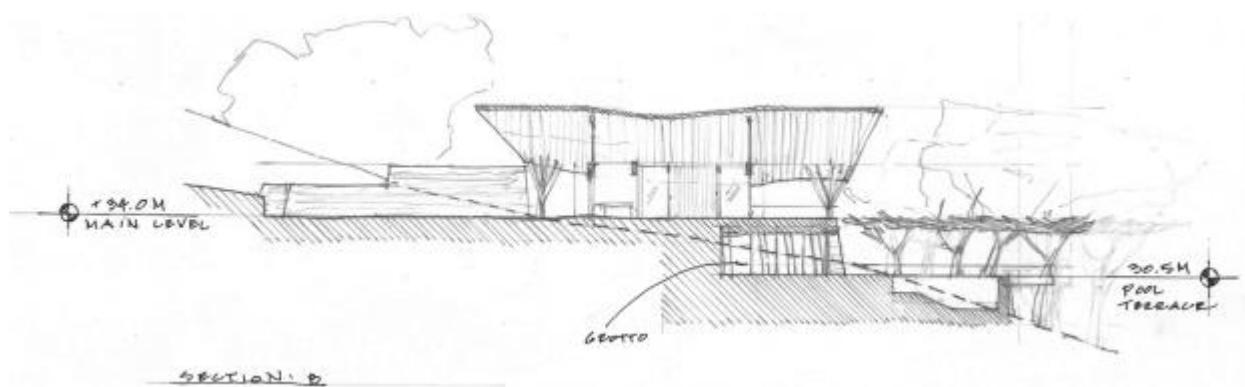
Planta B. Fuente: Planos de anteproyecto
